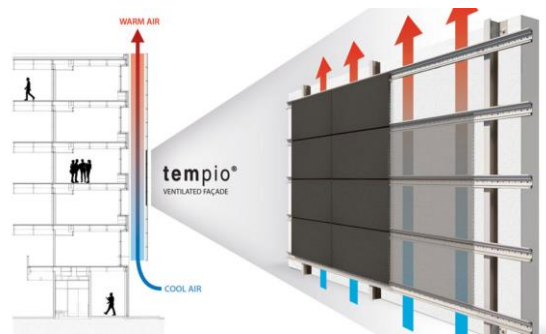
Ejemplo de fachada para muro cortina de doble piel.
